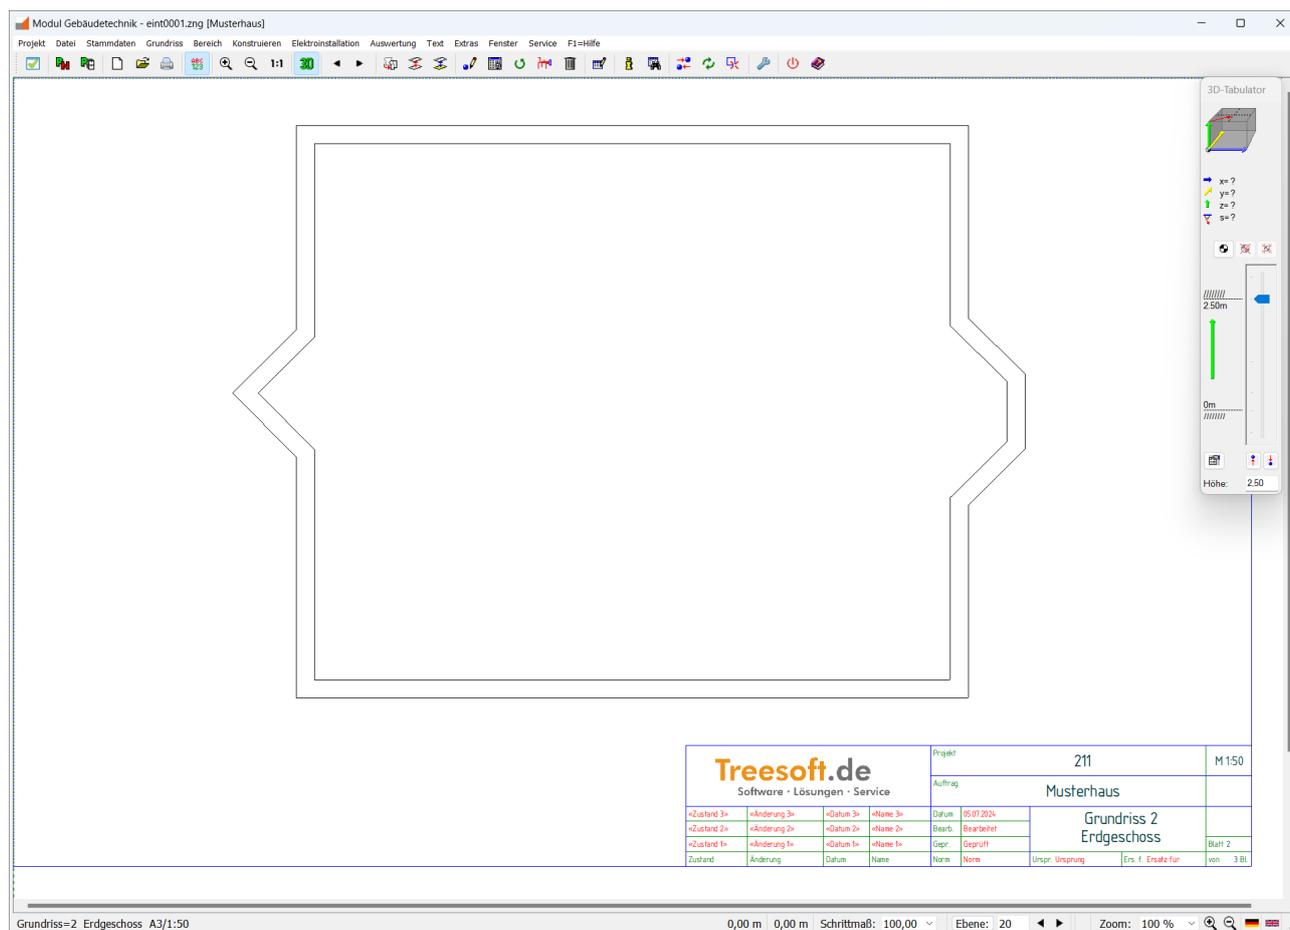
Vermittelter Grundriss
